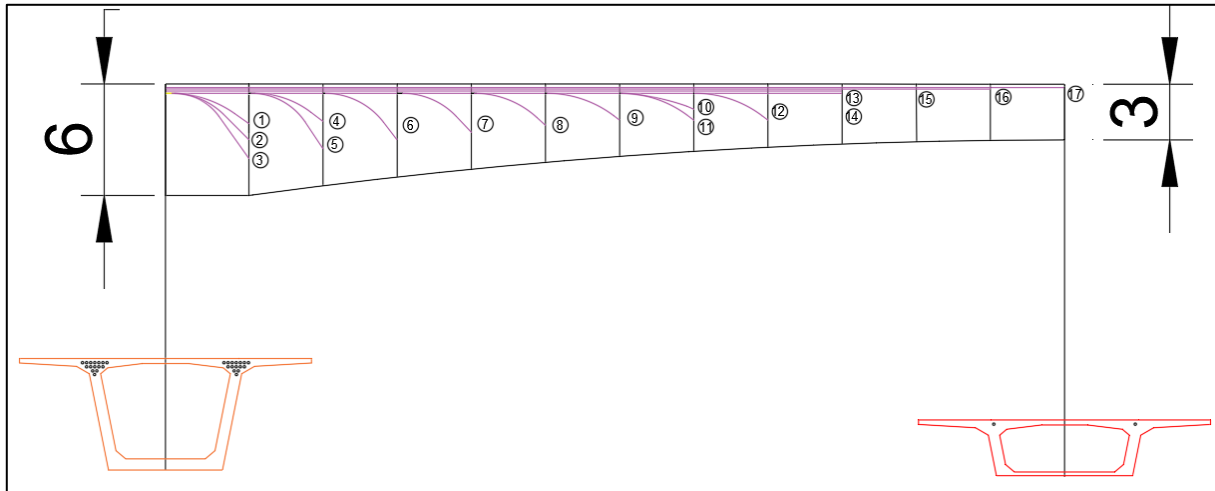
Tracé en élévation des câbles du demi-fléau.
